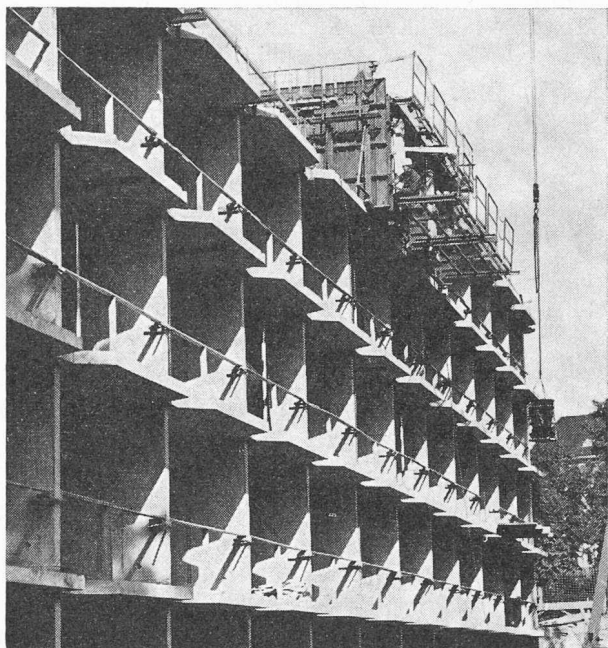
Façade d'un bâtiment exécuté avec un coffrage-tunnel.
